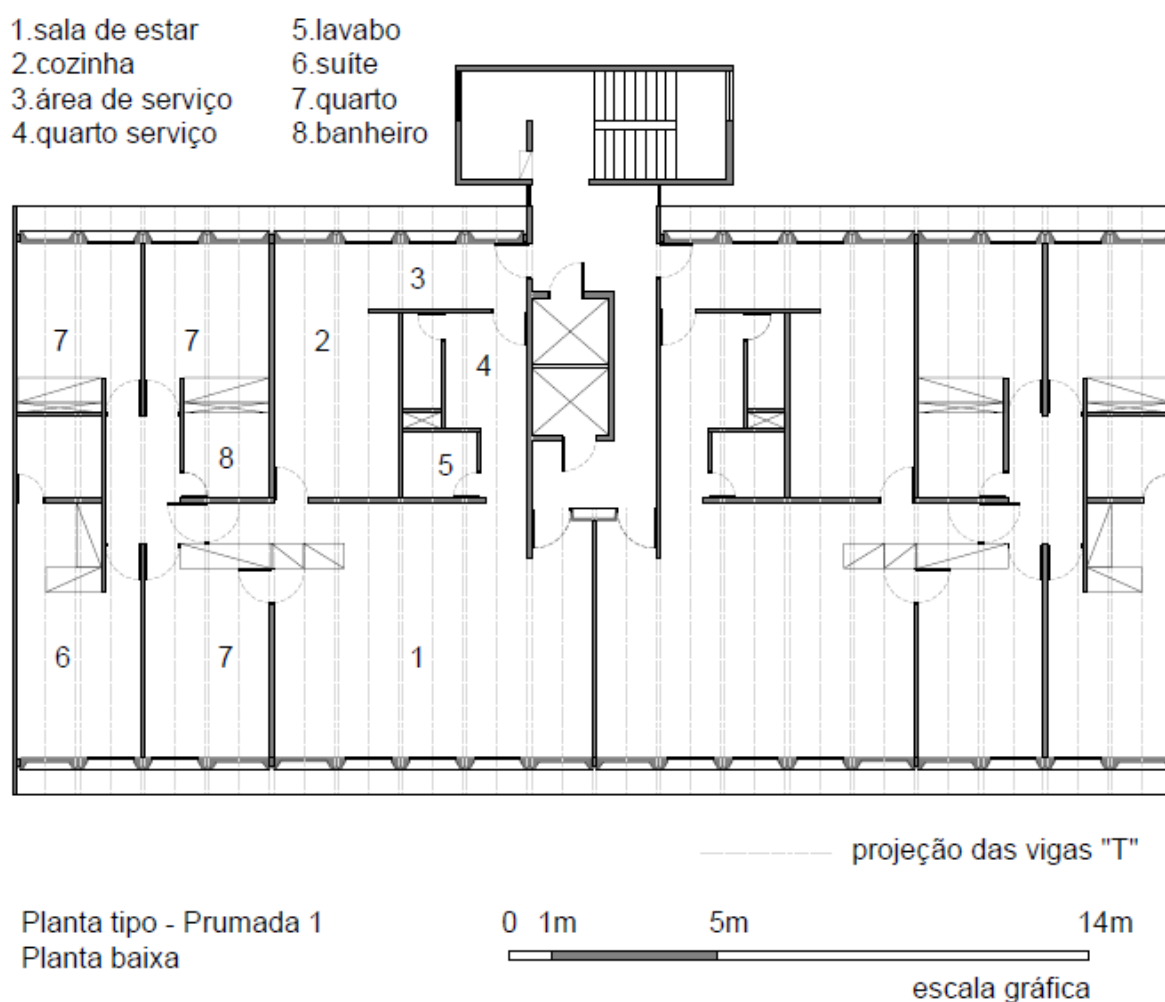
Planta tipo do R3 com base no projeto original. Esquema da autora, 2025.
